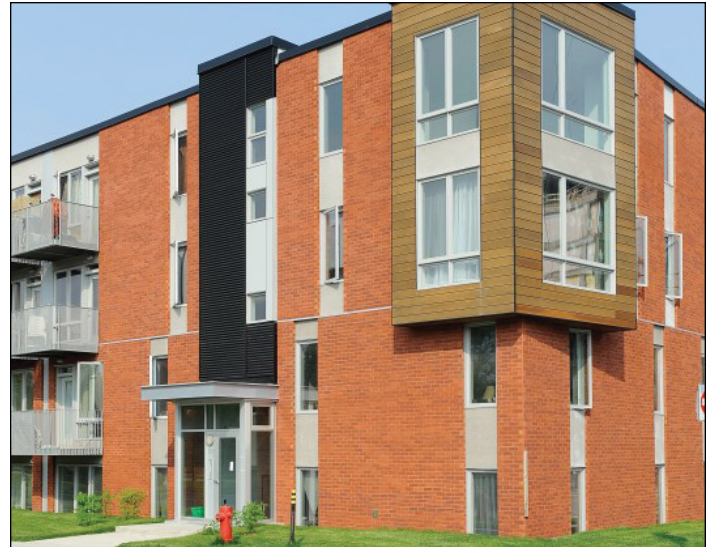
Emplacement proposé du futur mur solaire pour le préchauffage de l'air de ventilation, au-dessus de l'entrée avant du bâtiment sur la façade sud (Source : L'CEUF s.e.n.c.)
